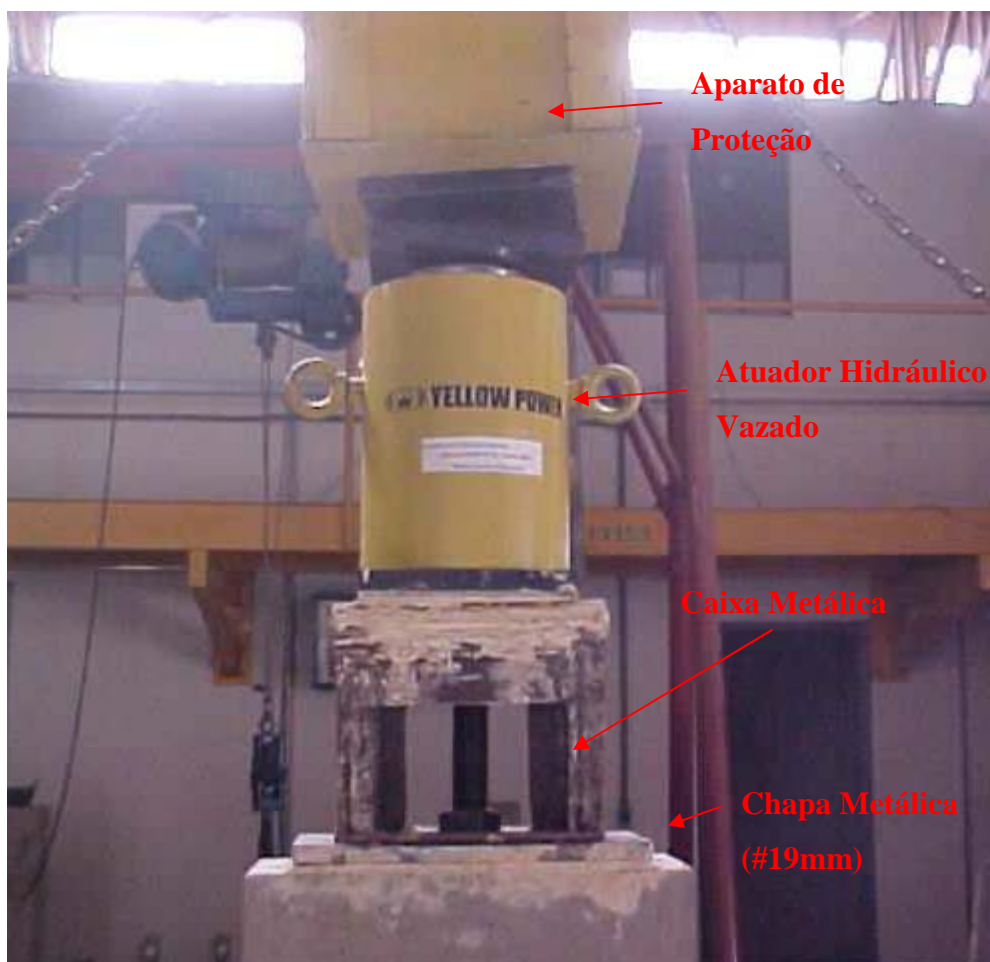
Equipamento utilizado para protensão na laje L1
